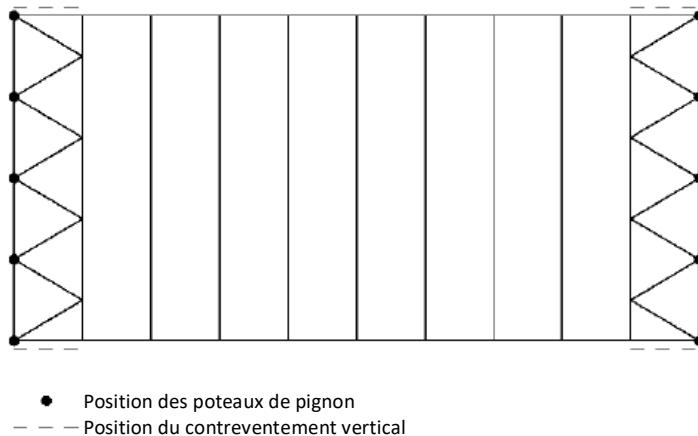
Disposition typique des contreventements de toiture (figure traduite de [5])
